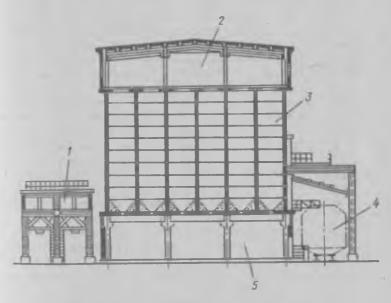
Силосное семенохранилище вместимостью 2,5 тыс. т: 1— отгрузна семян на автомобильный транспорт; 2— надсилосное помещение; 3— силосы; 4— приемка семян с железнодорожного транспорта; 5— подсилосное помещение
